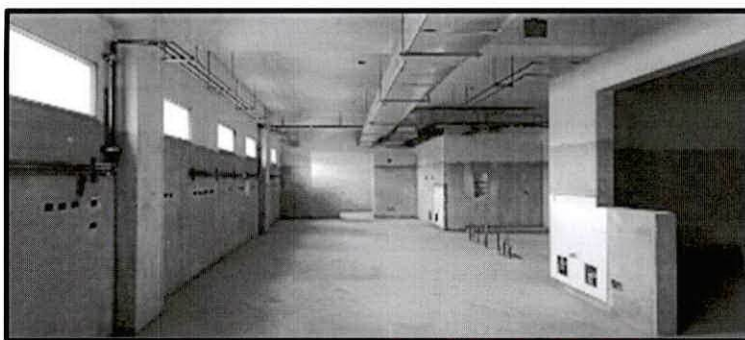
Ductos de HVAC y tuberías en los techos
